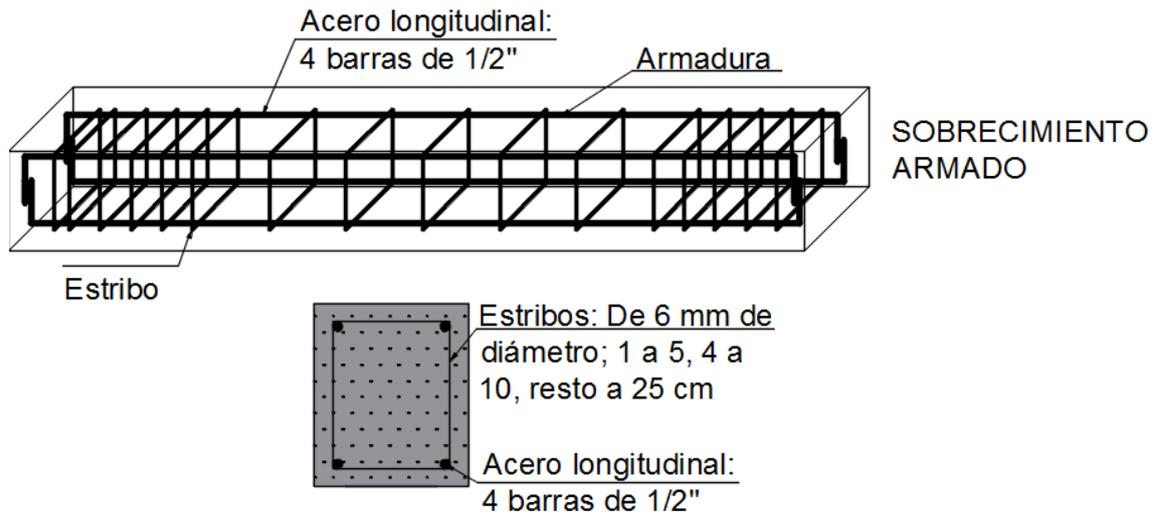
Detalle de acero mínimo en armadura de Sobrecimiento armado.
